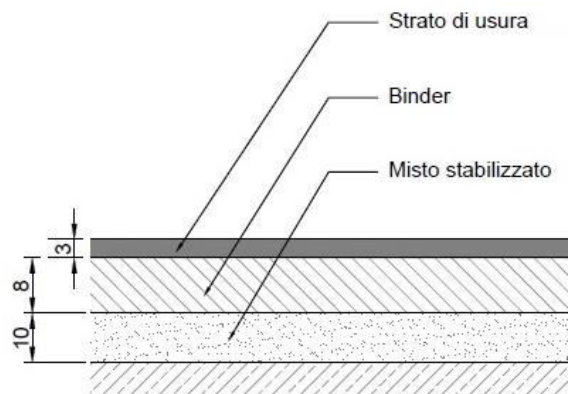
PARTICOLARE TIPOLOGICO "C" - Pavimentazione Industriale
